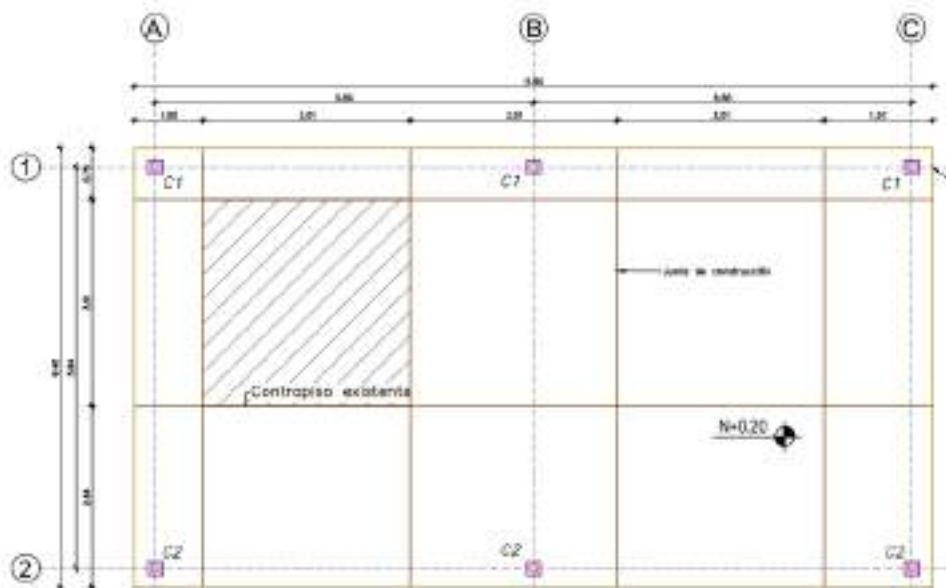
Plano de Contrapiso y Juntas de construcción.
